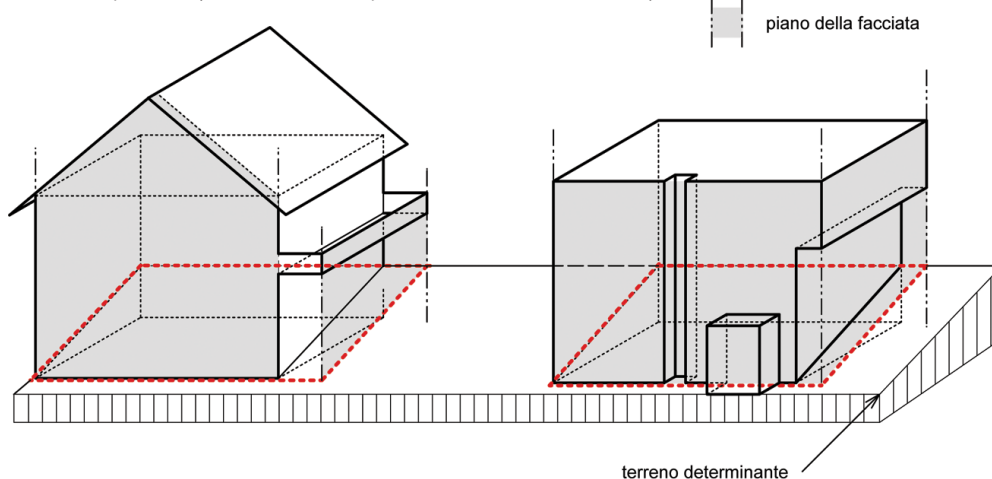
e 3.3 Piano della facciata e base delle facciate
